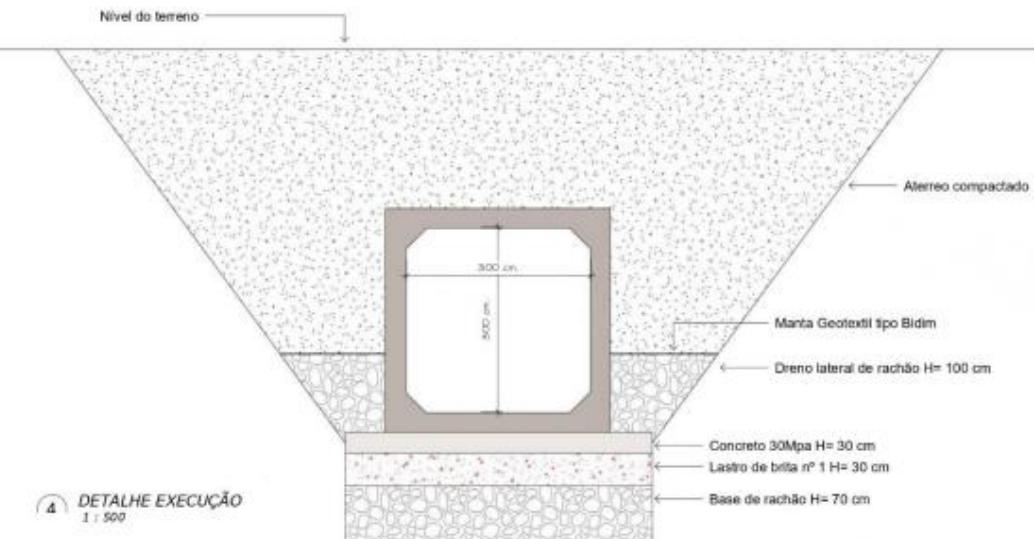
Detalhe da estrutura da canalização. Fonte: RCA.
